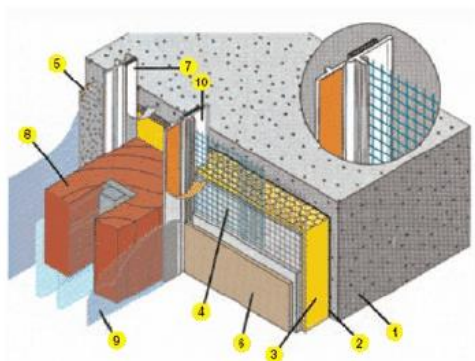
Detail aplikace výztužné síťoviny u fasádních otvorů
